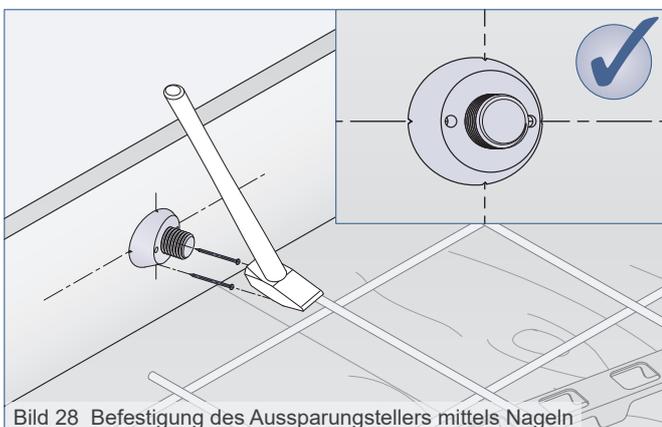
Befestigung des Aussparungstellers mittels Nageln
